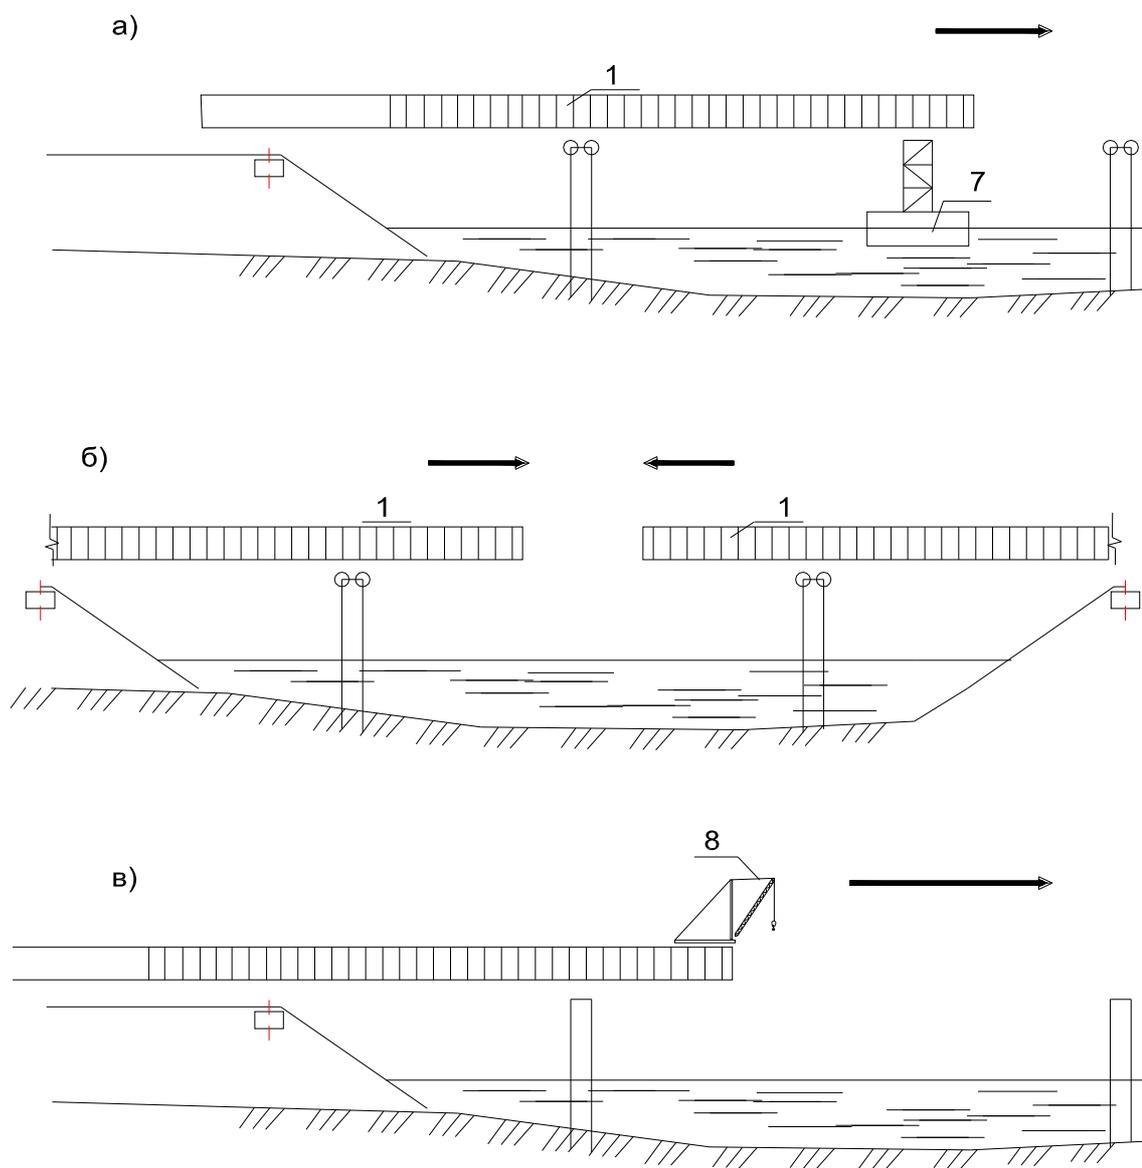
Схемы монтажа металлической части балочных неразрезных сталежелезобетонных пролетных строений: а- продольная надвигка по постоянным опорам с плавучей опорой; б -продольная надвигка с двух берегов по постоянным опорам;в -навесная сборка. 1-надвигаемая стальная конструкция; 8-монтажный кран на смонтированной части пролетного строения
